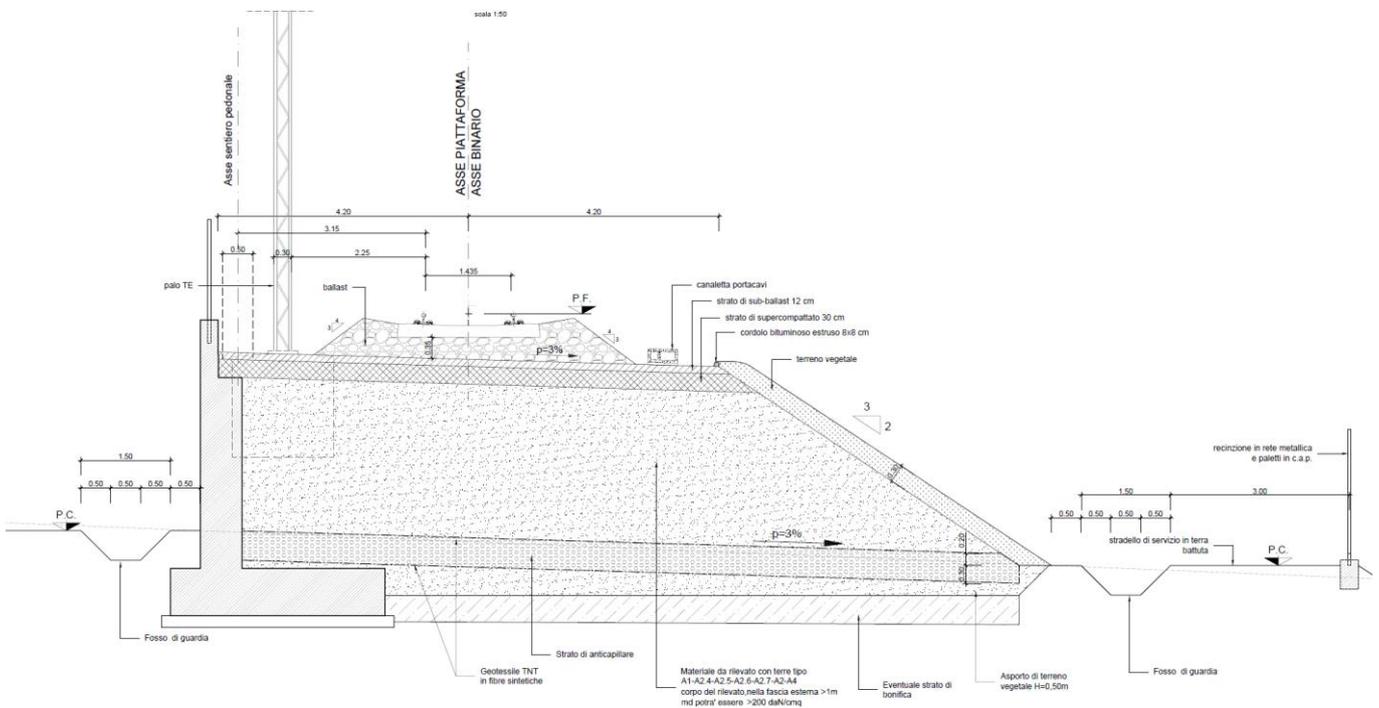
Sezione tipo a singolo binario in rilevato con muro
